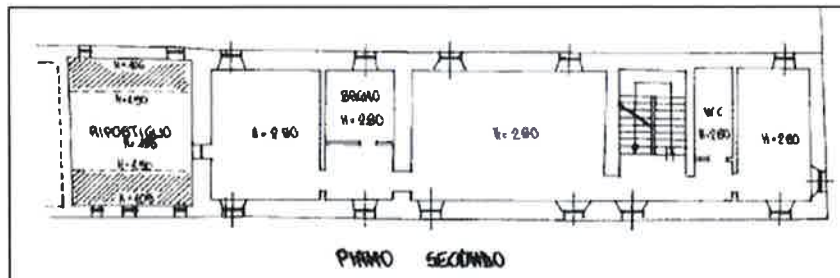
planimetria catastale del piano secondo dell'abitazione identificata con la particella 1184 sub 5
